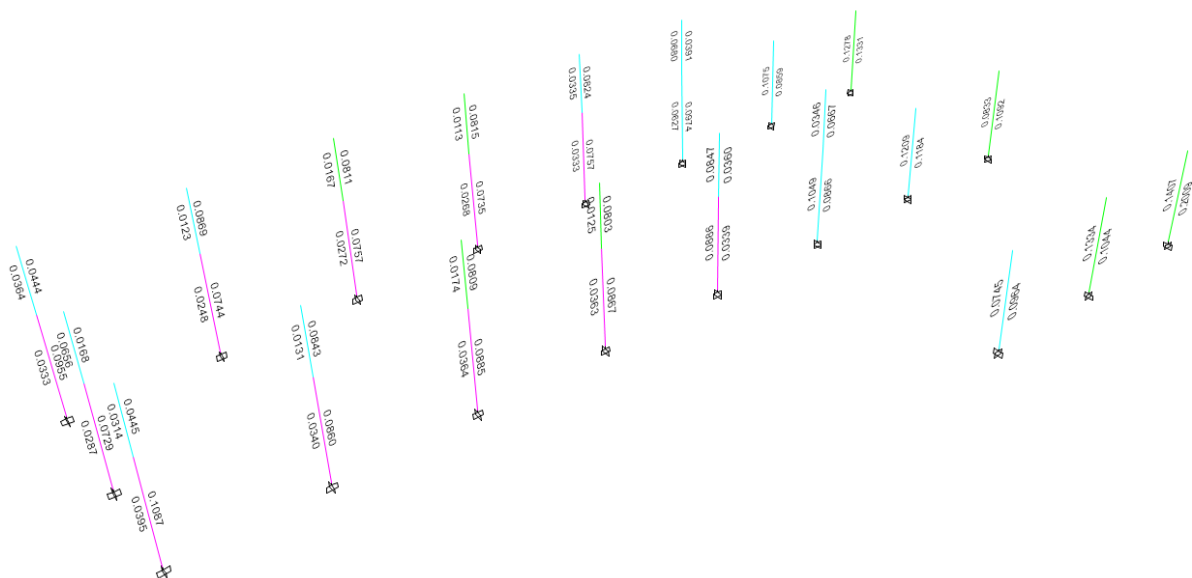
Refuerzo transversal en columnas de restaurante en cm2
